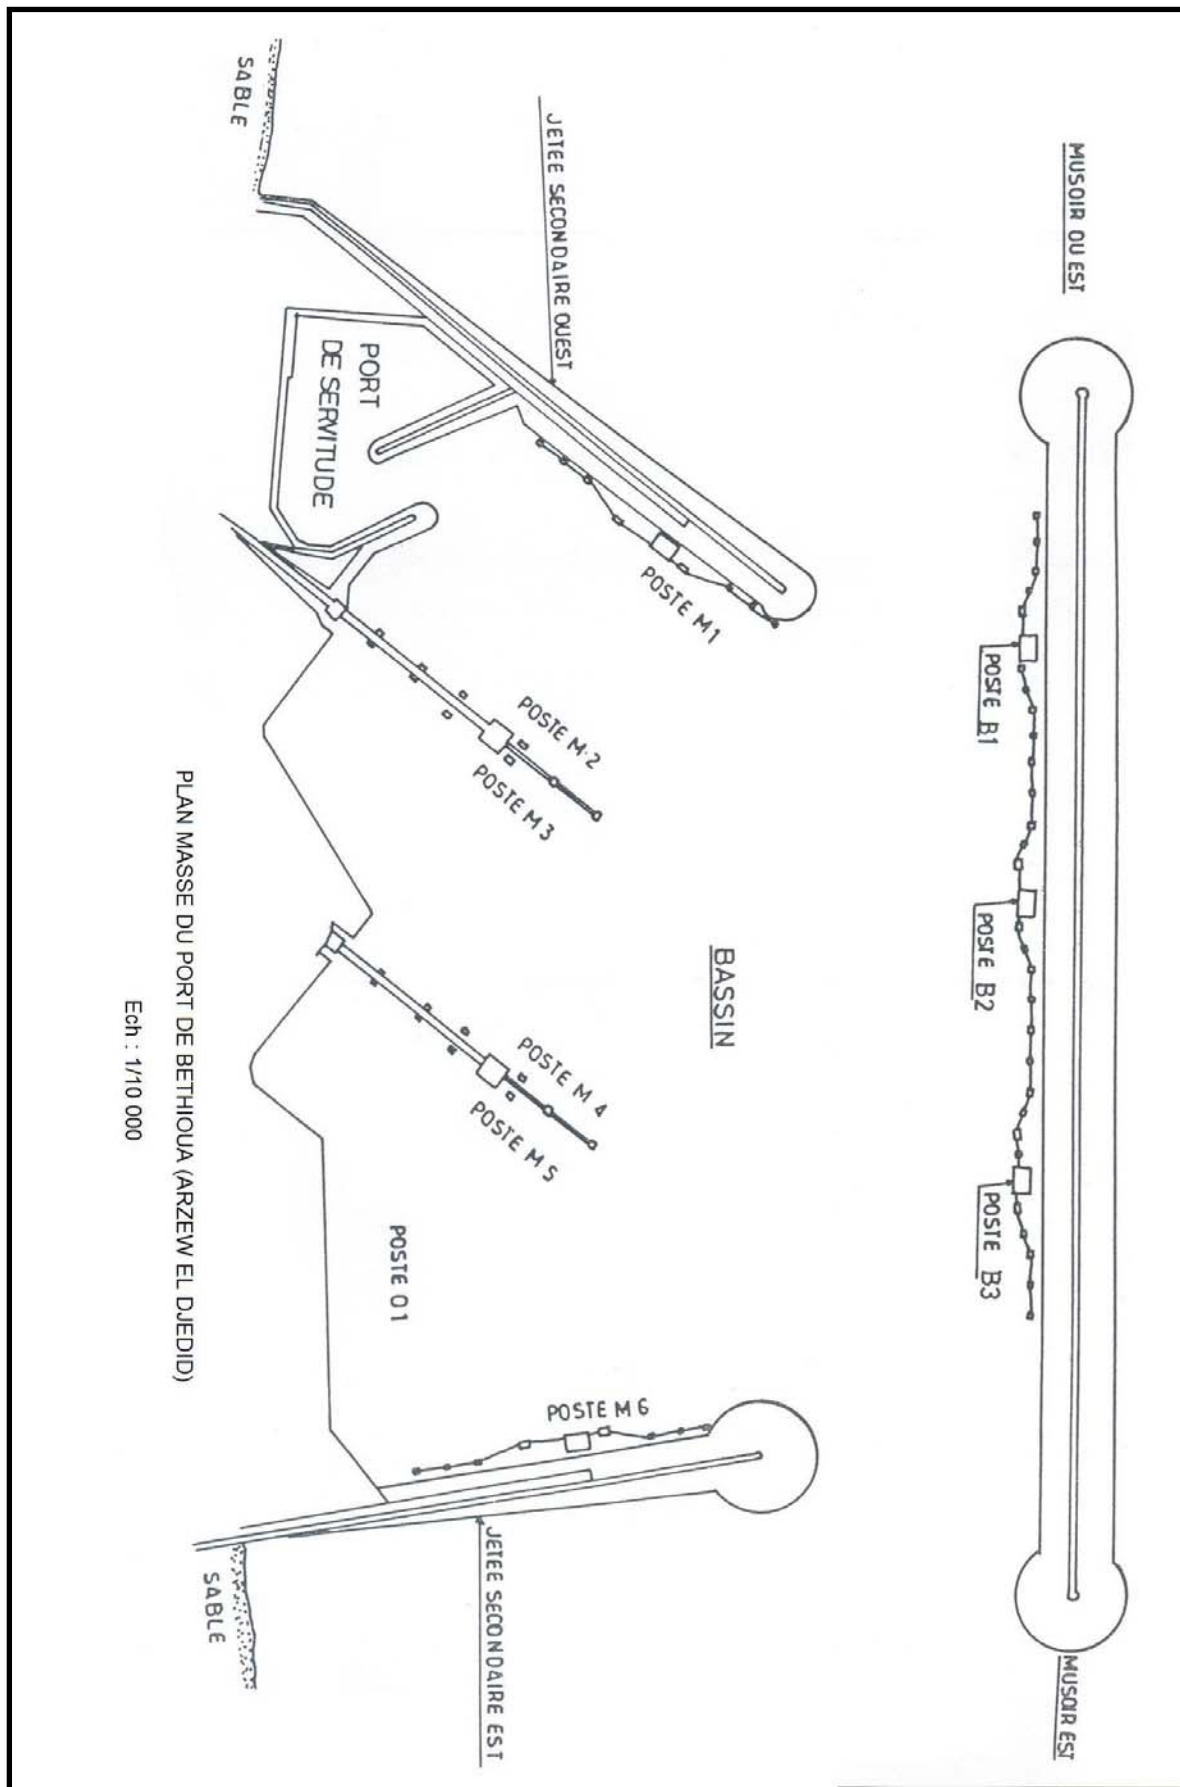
Plan Masse du port pétrolier de Bethioua
